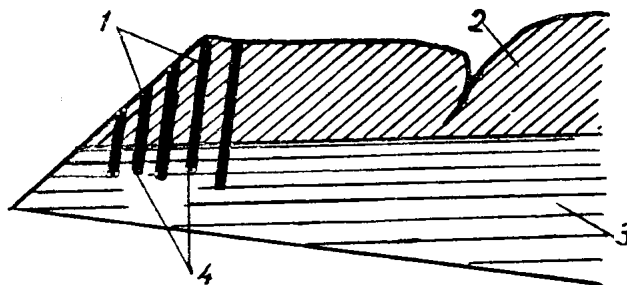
Укріплення зсувного схилу за допомогою залізобетонних шпильок:
